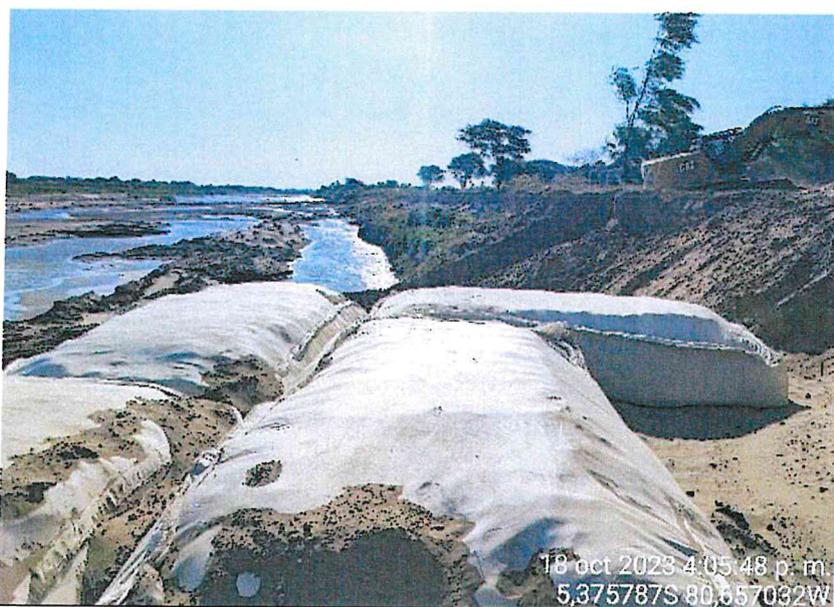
Vista de hydrobolsas colocadas en proyección con el cauce natural del río Piura aguas arriba.
